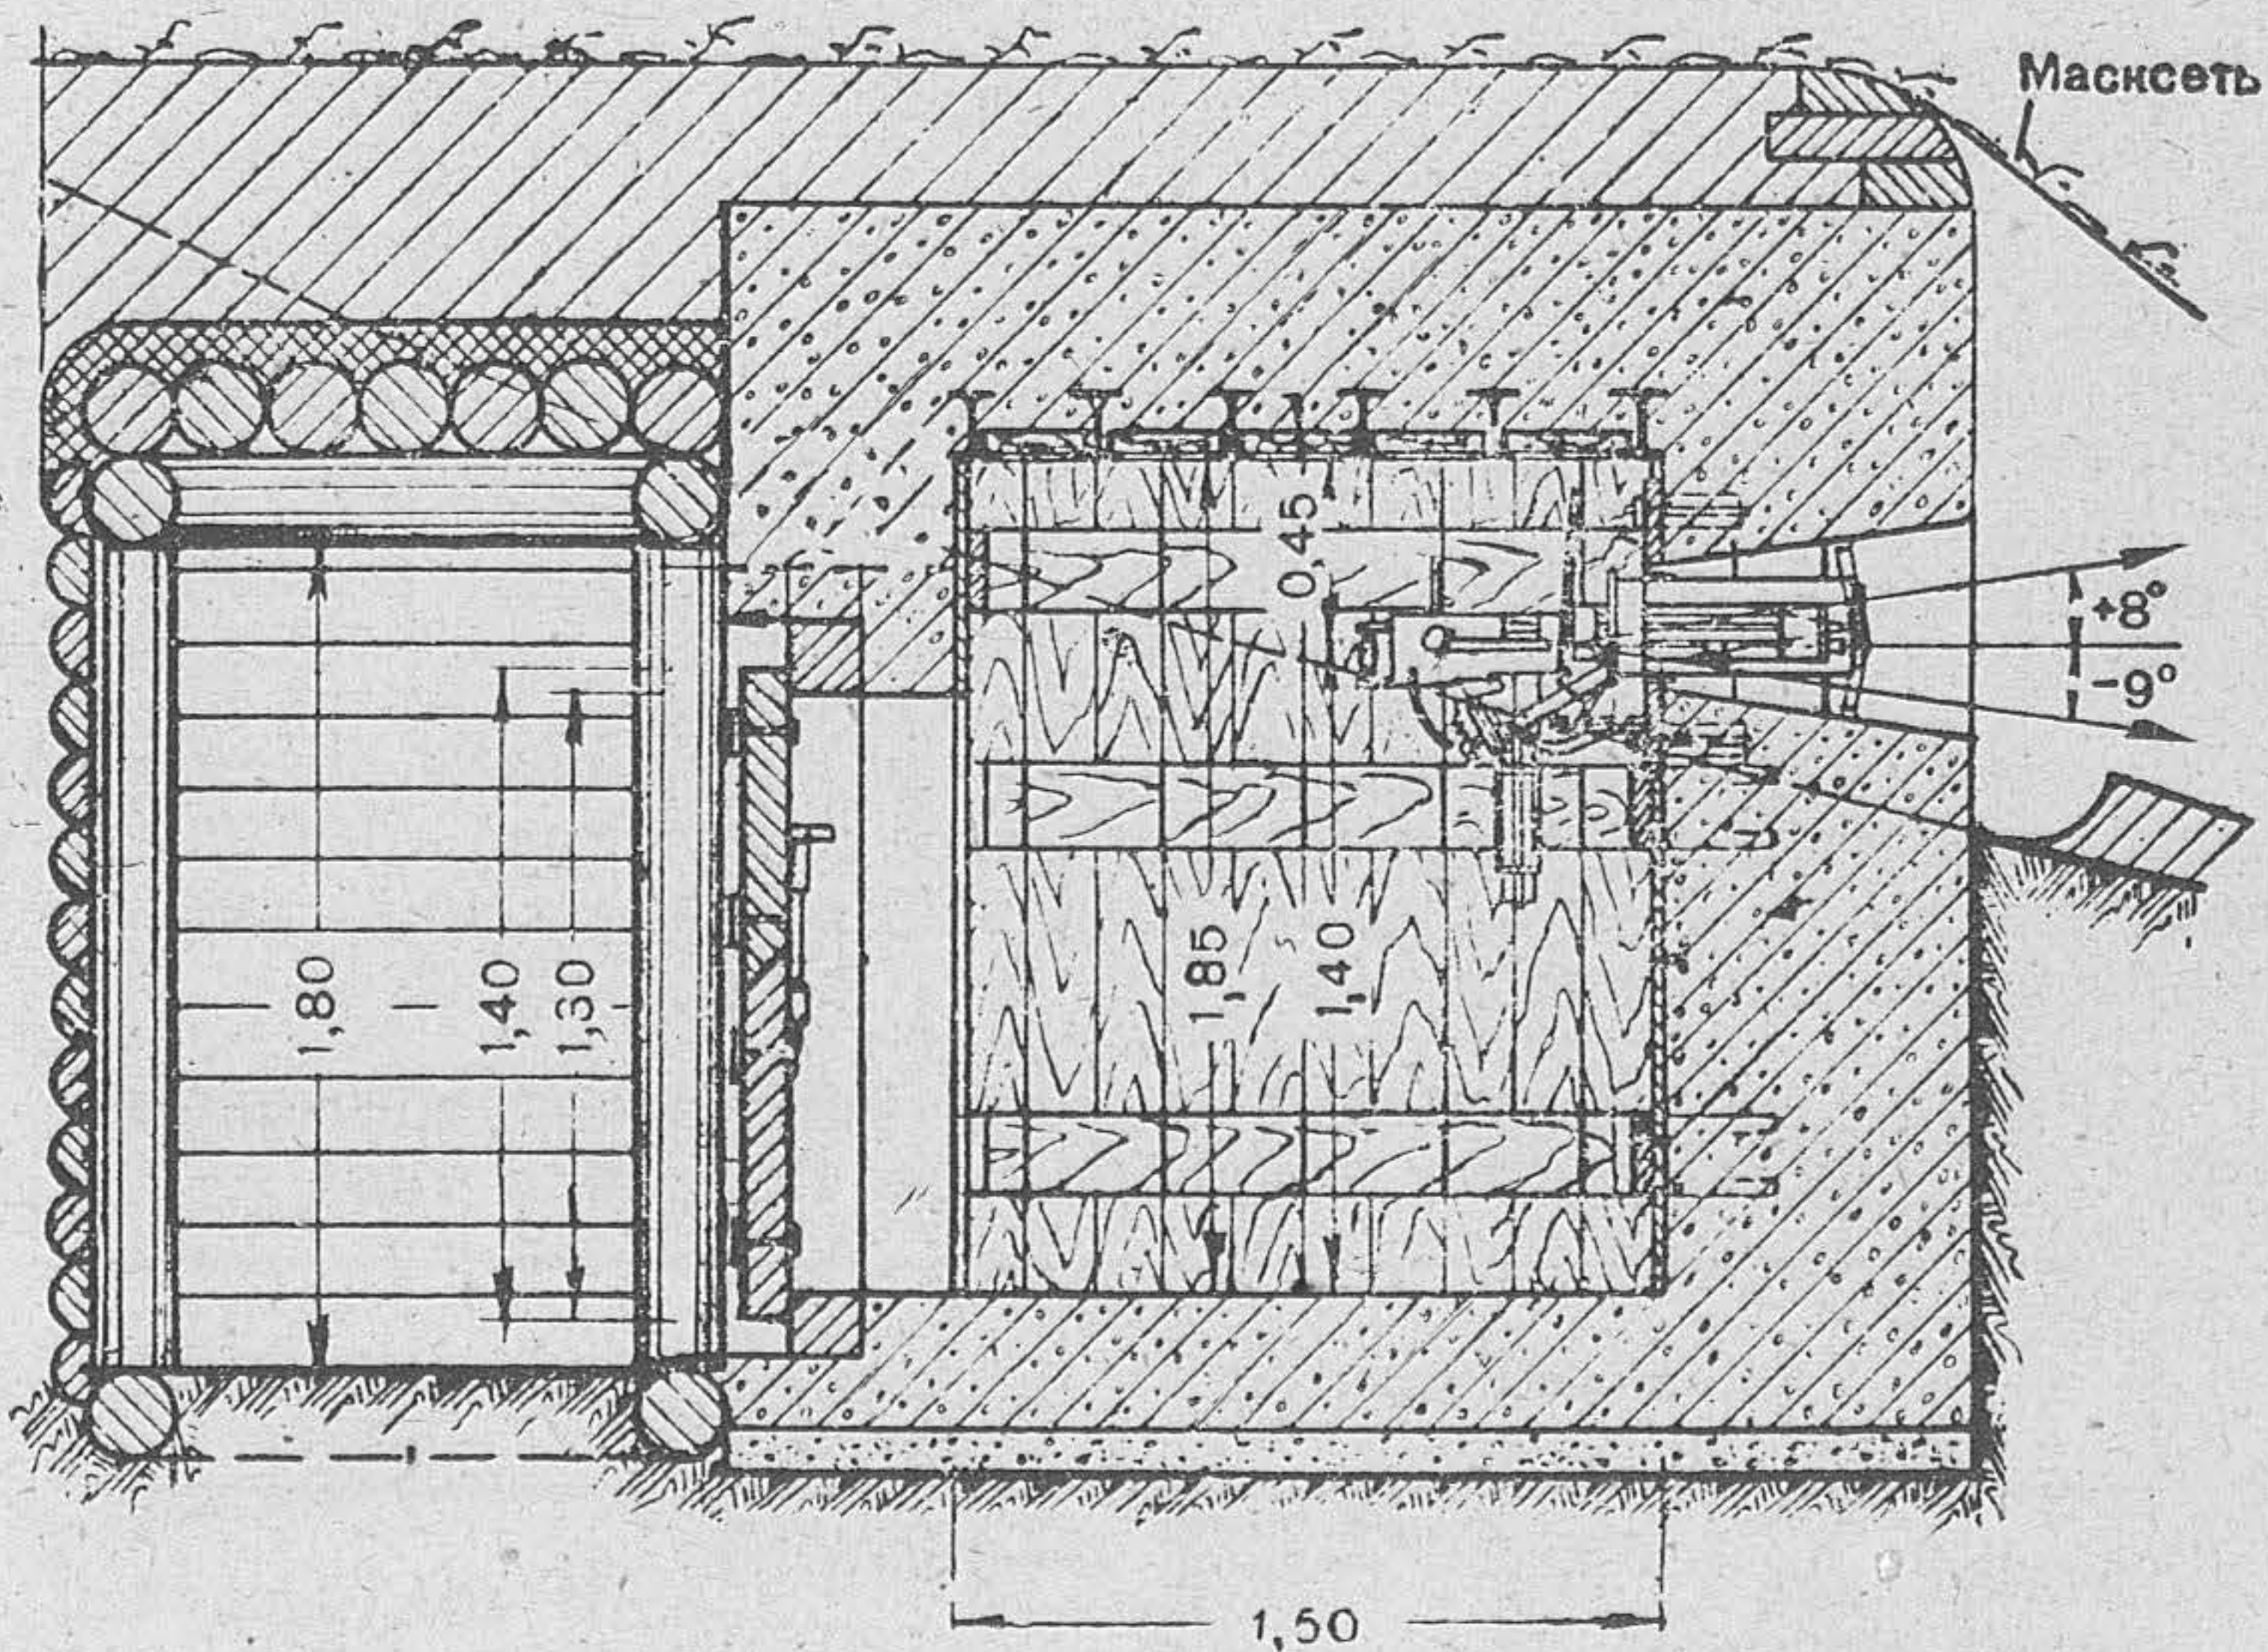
а. Монолитное железобетонное пулемётное сооружение фронтального действия (разрез)
